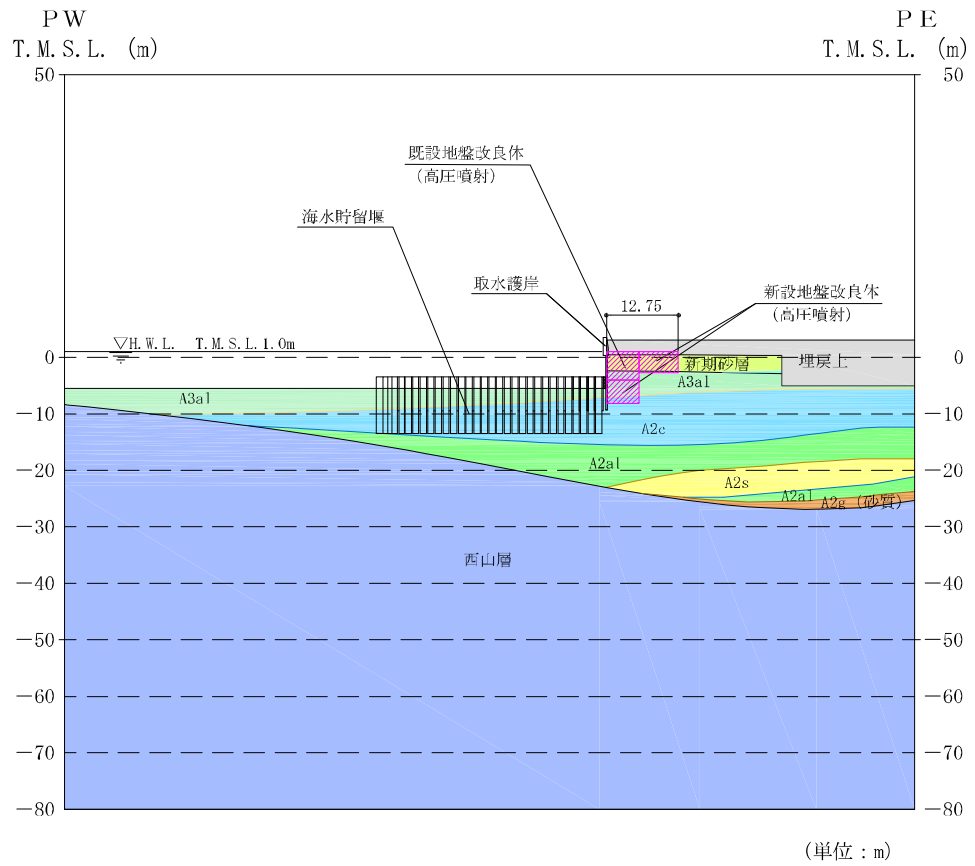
取水護岸の評価対象断面図 (A-A断面)
